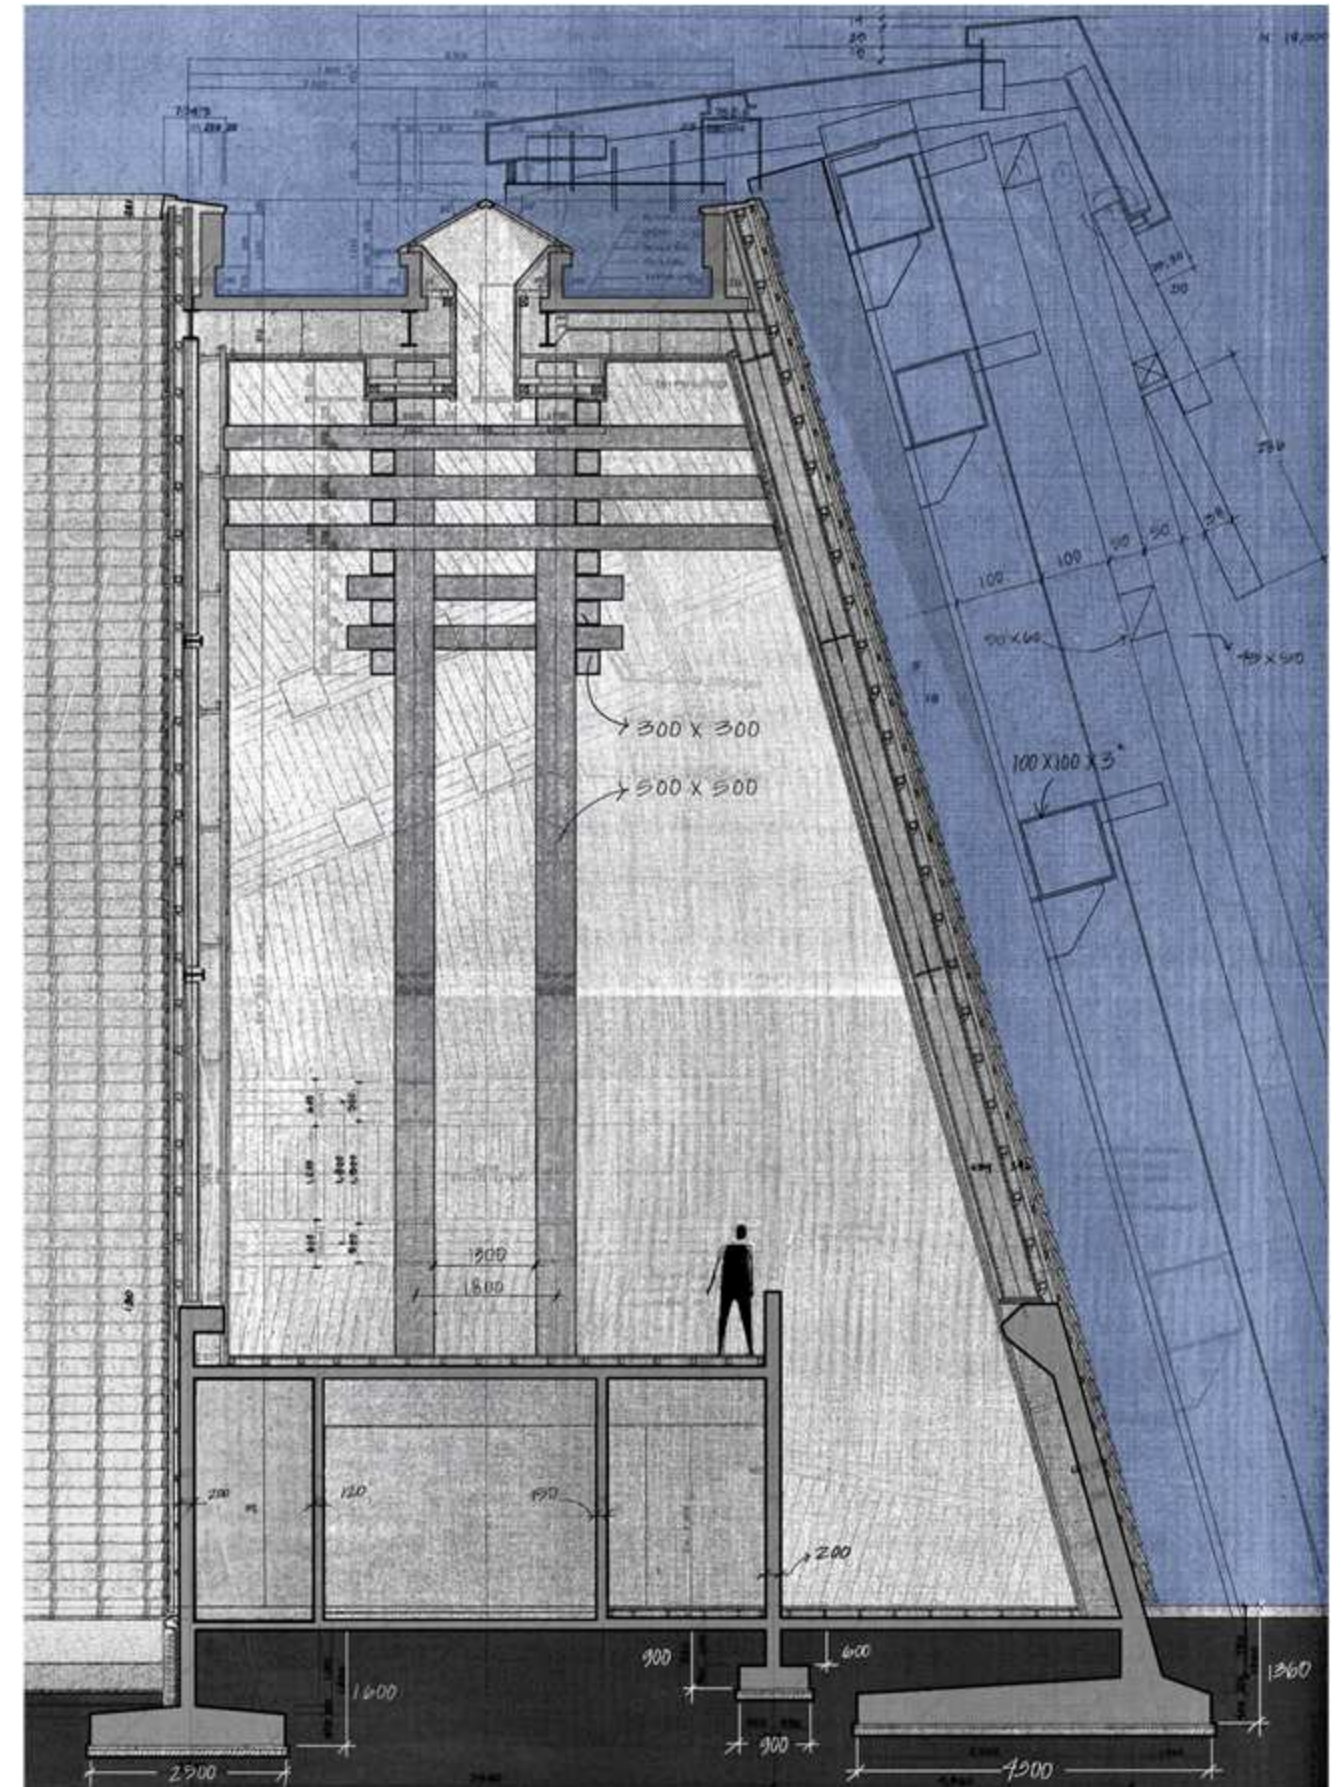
Sección y detalle de edificio principal. Ando (2000), pág. 358. [Editado por Jade Castellanos].
